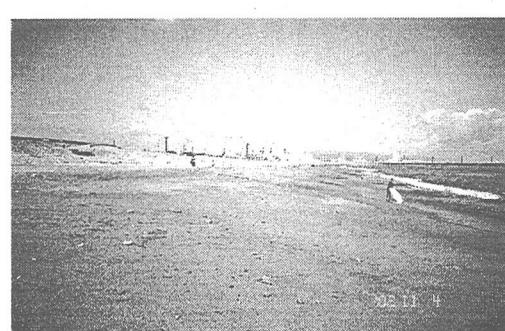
沖合防波堤による波の遮蔽域内の海岸状況
